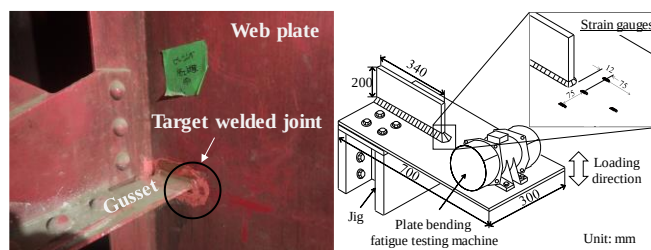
対象の溶接継手部 図-2 試験体寸法と試験機
